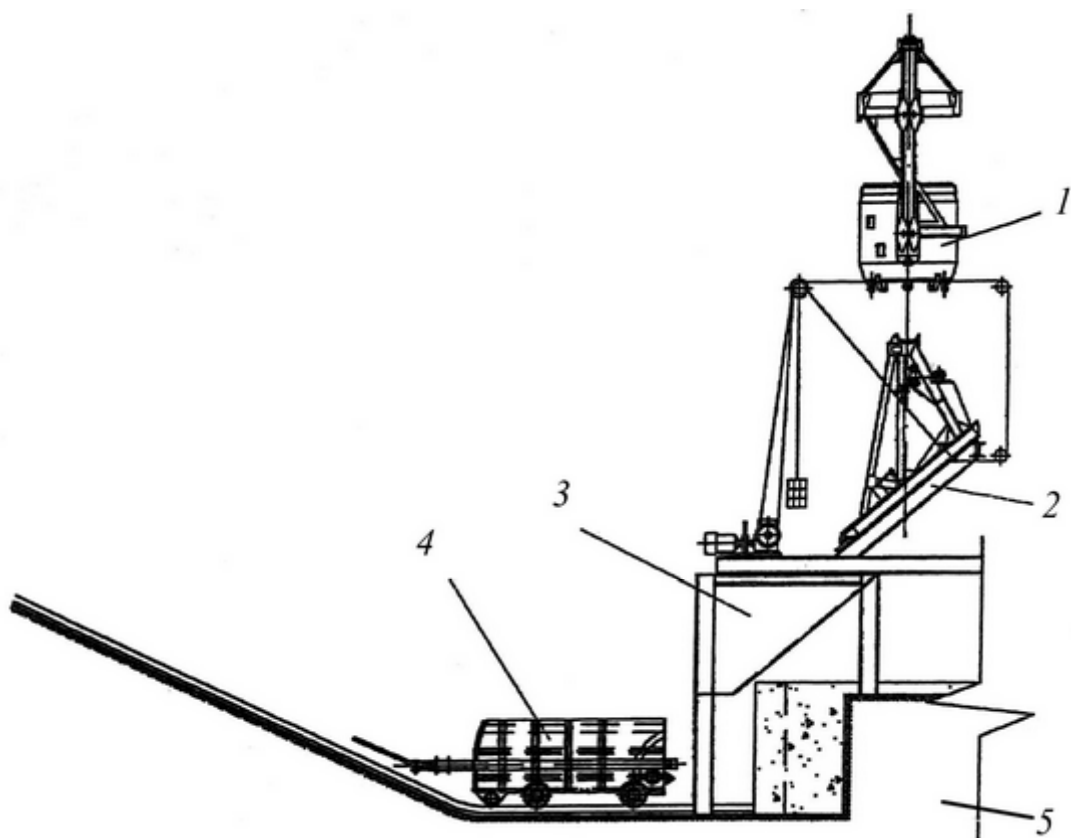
Схема разгрузки бадей на нулевой площадке по патенту [6]:
